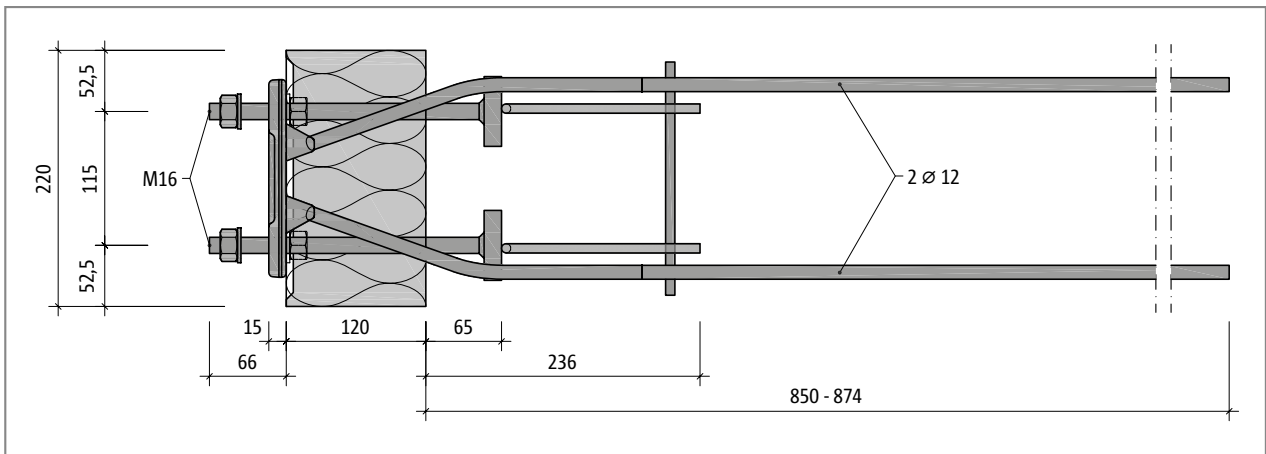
Schöck Isokorb® Typ QSXT12: Grundriss
